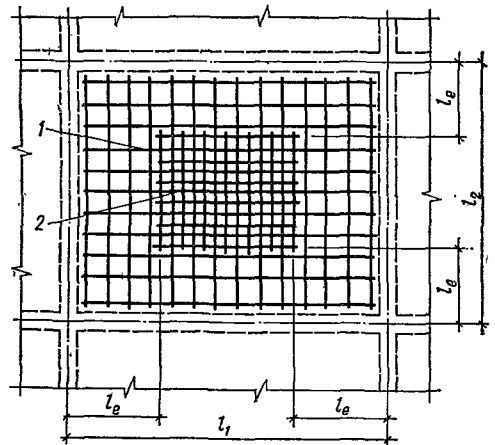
Схема армирования пролета плиты, опертой по контуру, основной (1) и дополнительной (2) цельными сварными сетками.
